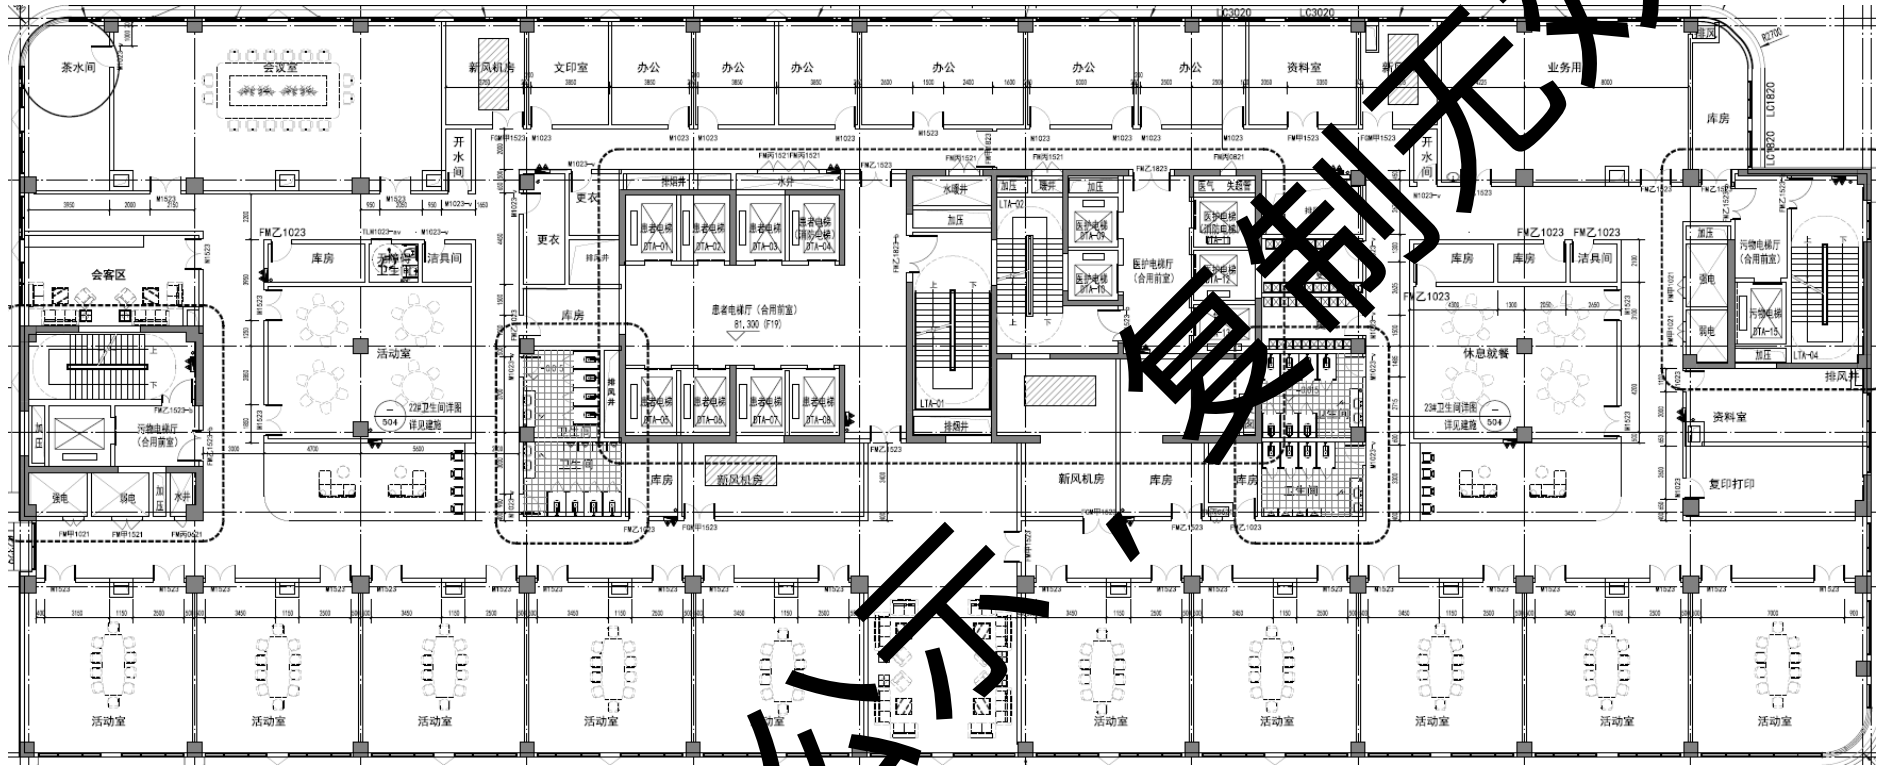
本项目新建住院综合楼 19F 平面布置图
